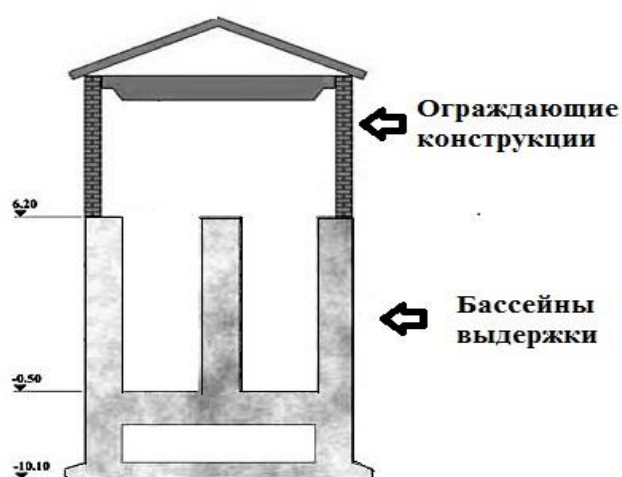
Поперечный разрез аварийного хранилища ОЯТ атомных подводных лодок
